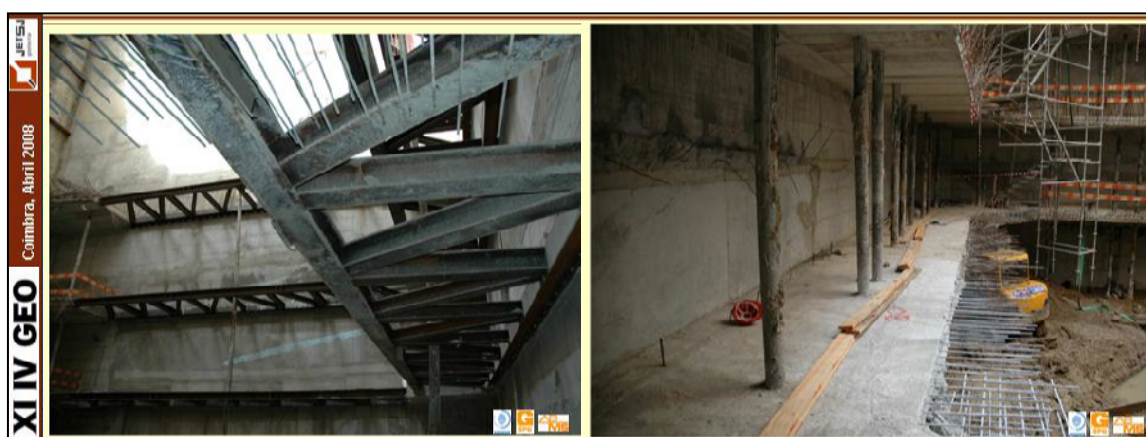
Vista dos travamentos conferidos pelas treliças metálicas e pelos troços de laje
